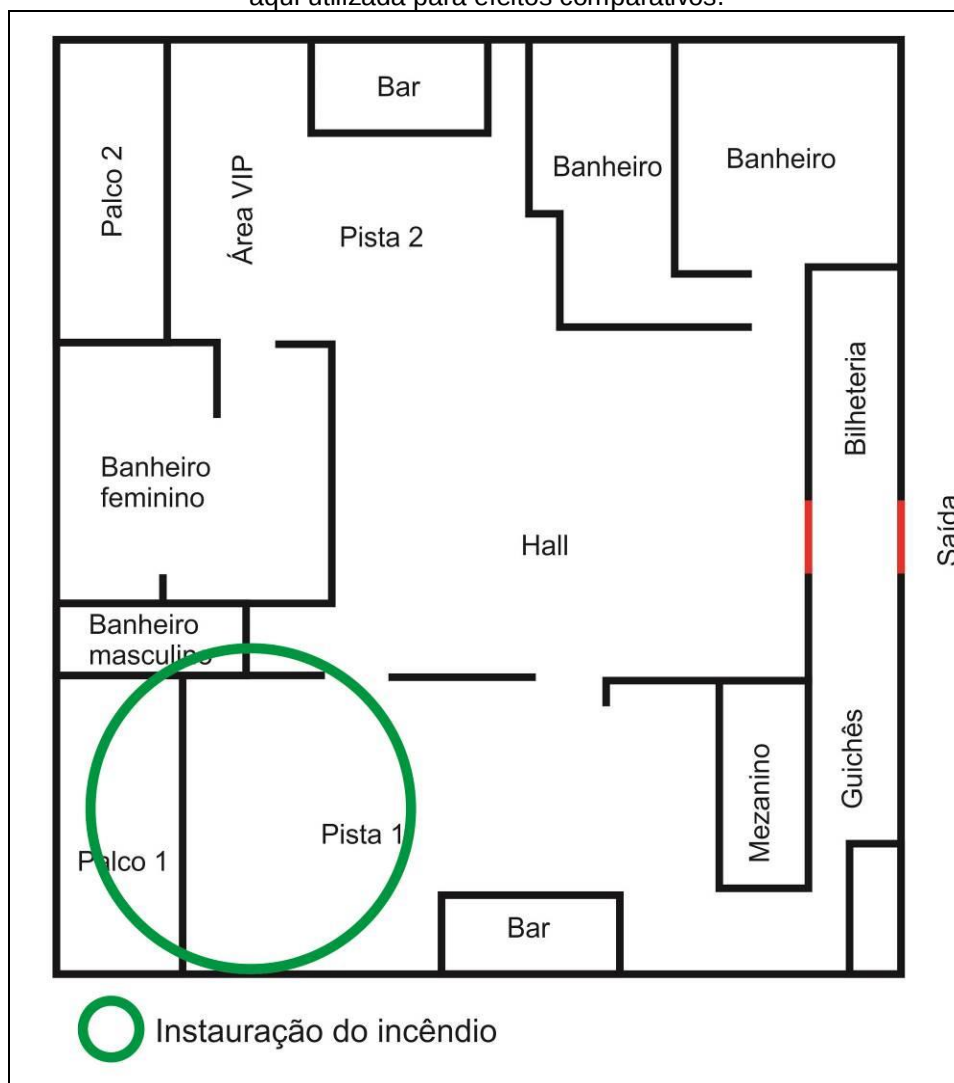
Planta baixa oficial da Boate Kiss, com demonstrativo da área de instauração do incêndio.
